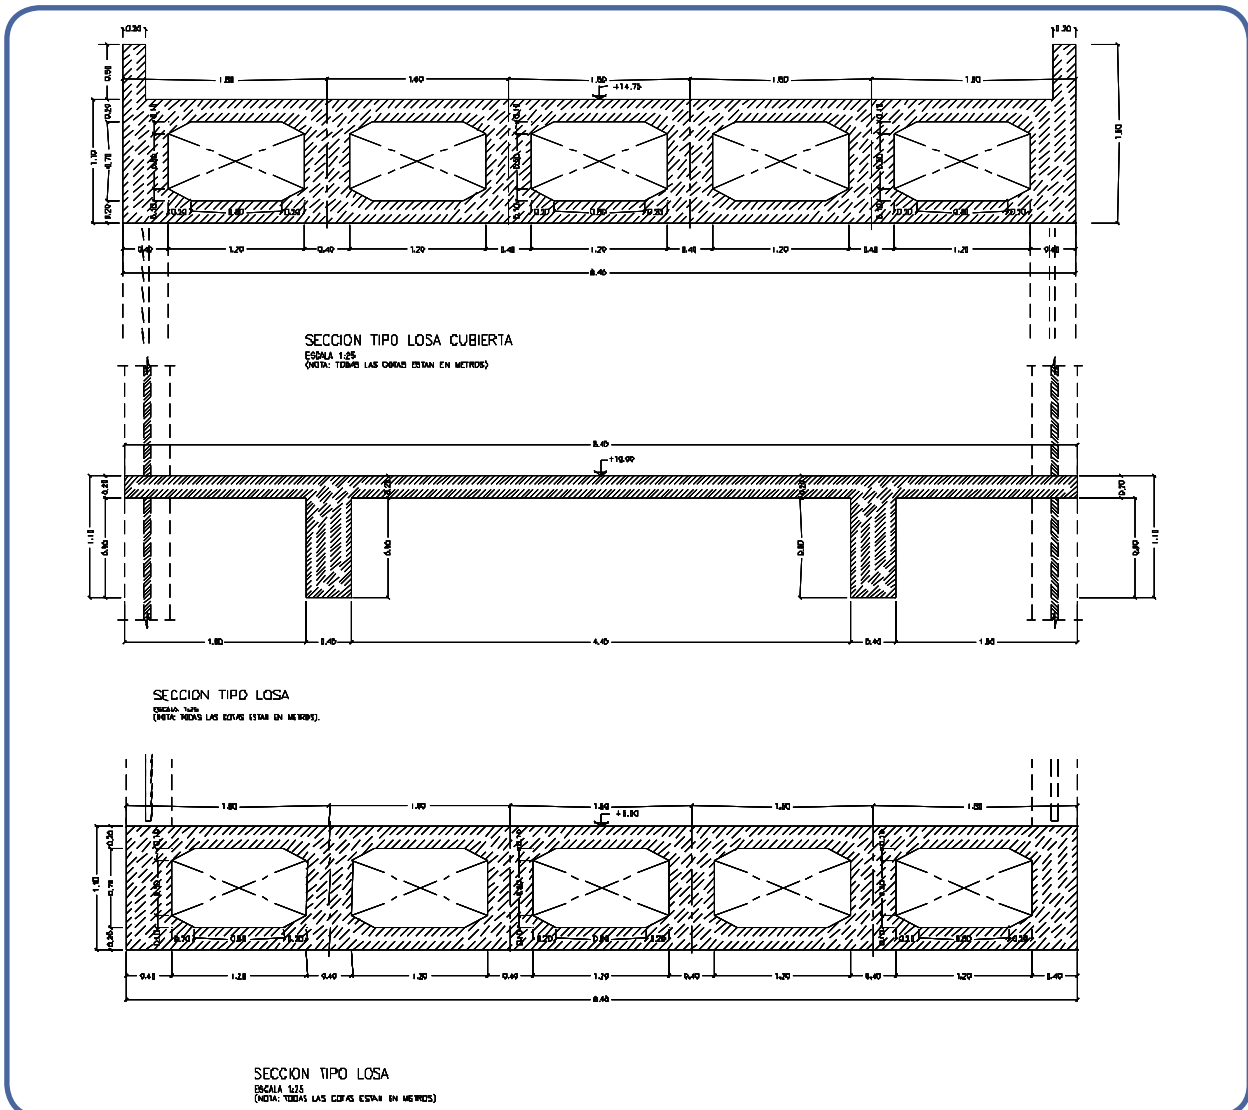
Secciones transversales de las tres losas, de arriba abajo, cubierta, forjado intermedio y forjado superior
